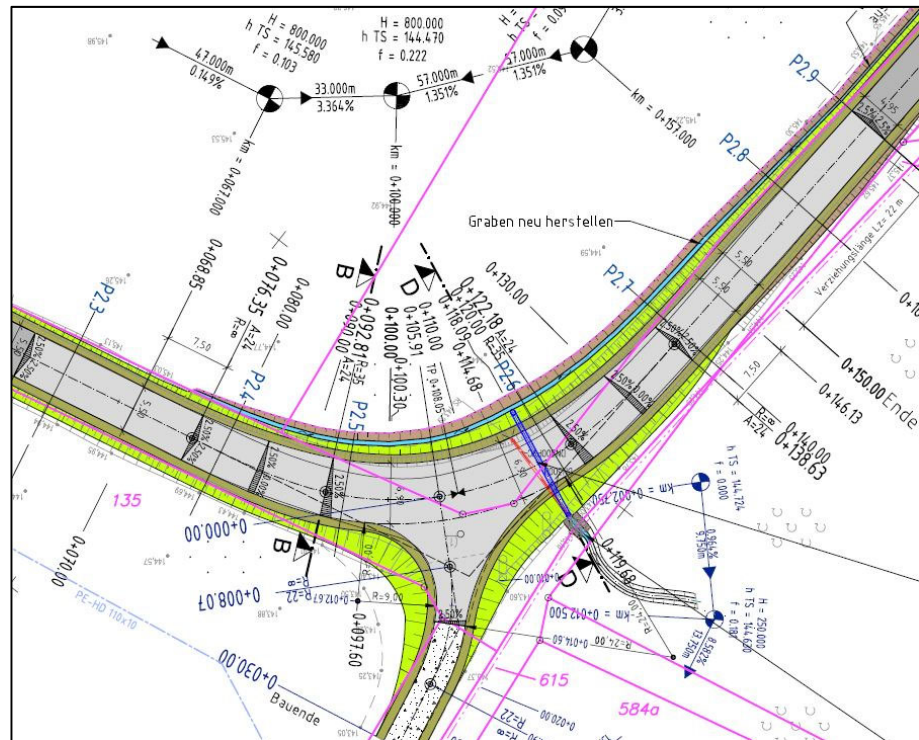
Auszug aus einem Lageplan (LASuV, 2014)
